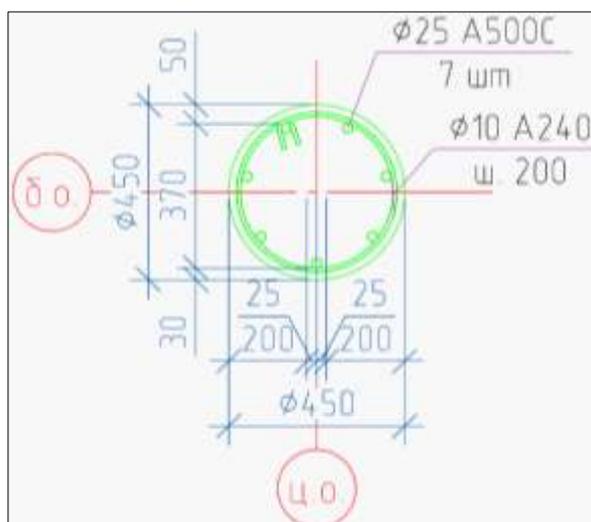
Принципиальная схема армирования колонны круглого поперечного сечения, полученная из расчётов
